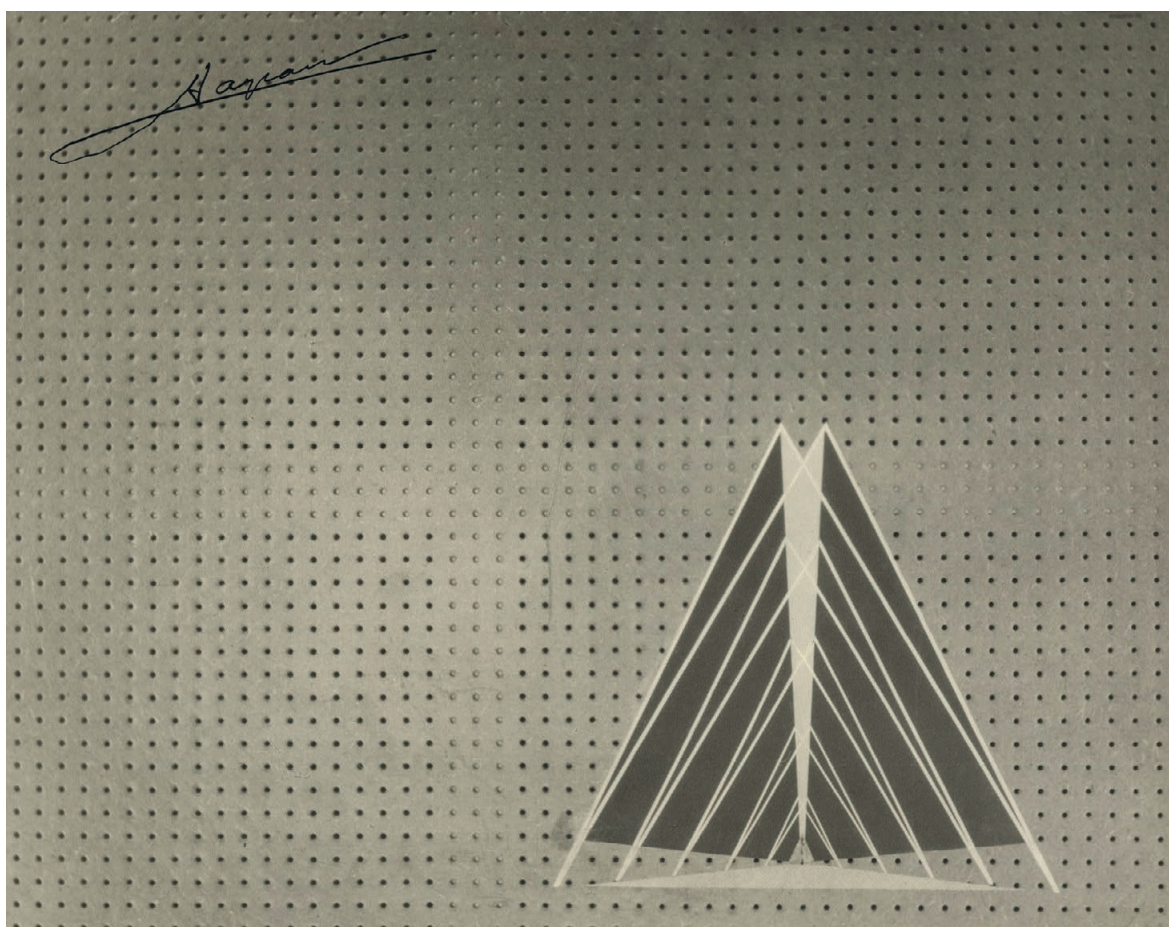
Cubillo. Anteproyecto de centro parroquial en el poblado dirigido de Canillas, 1958. Sección.
